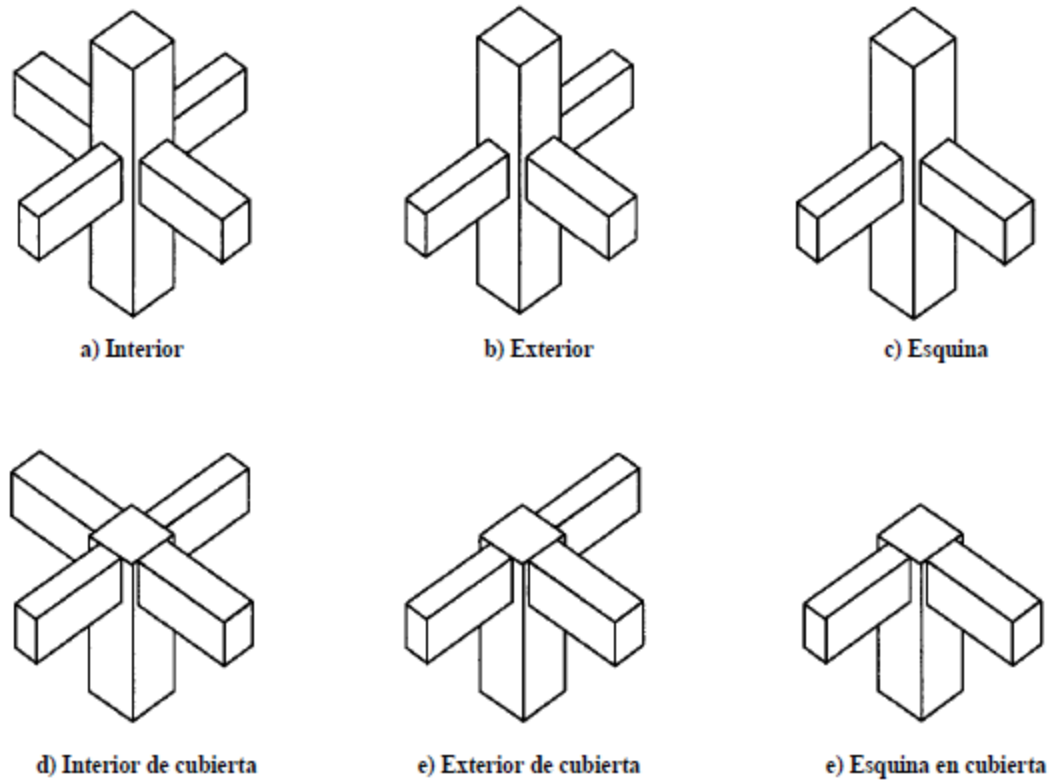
Conexiones típicas viga-columna (no se muestra la losa). No se muestran casos de viga ancha.
